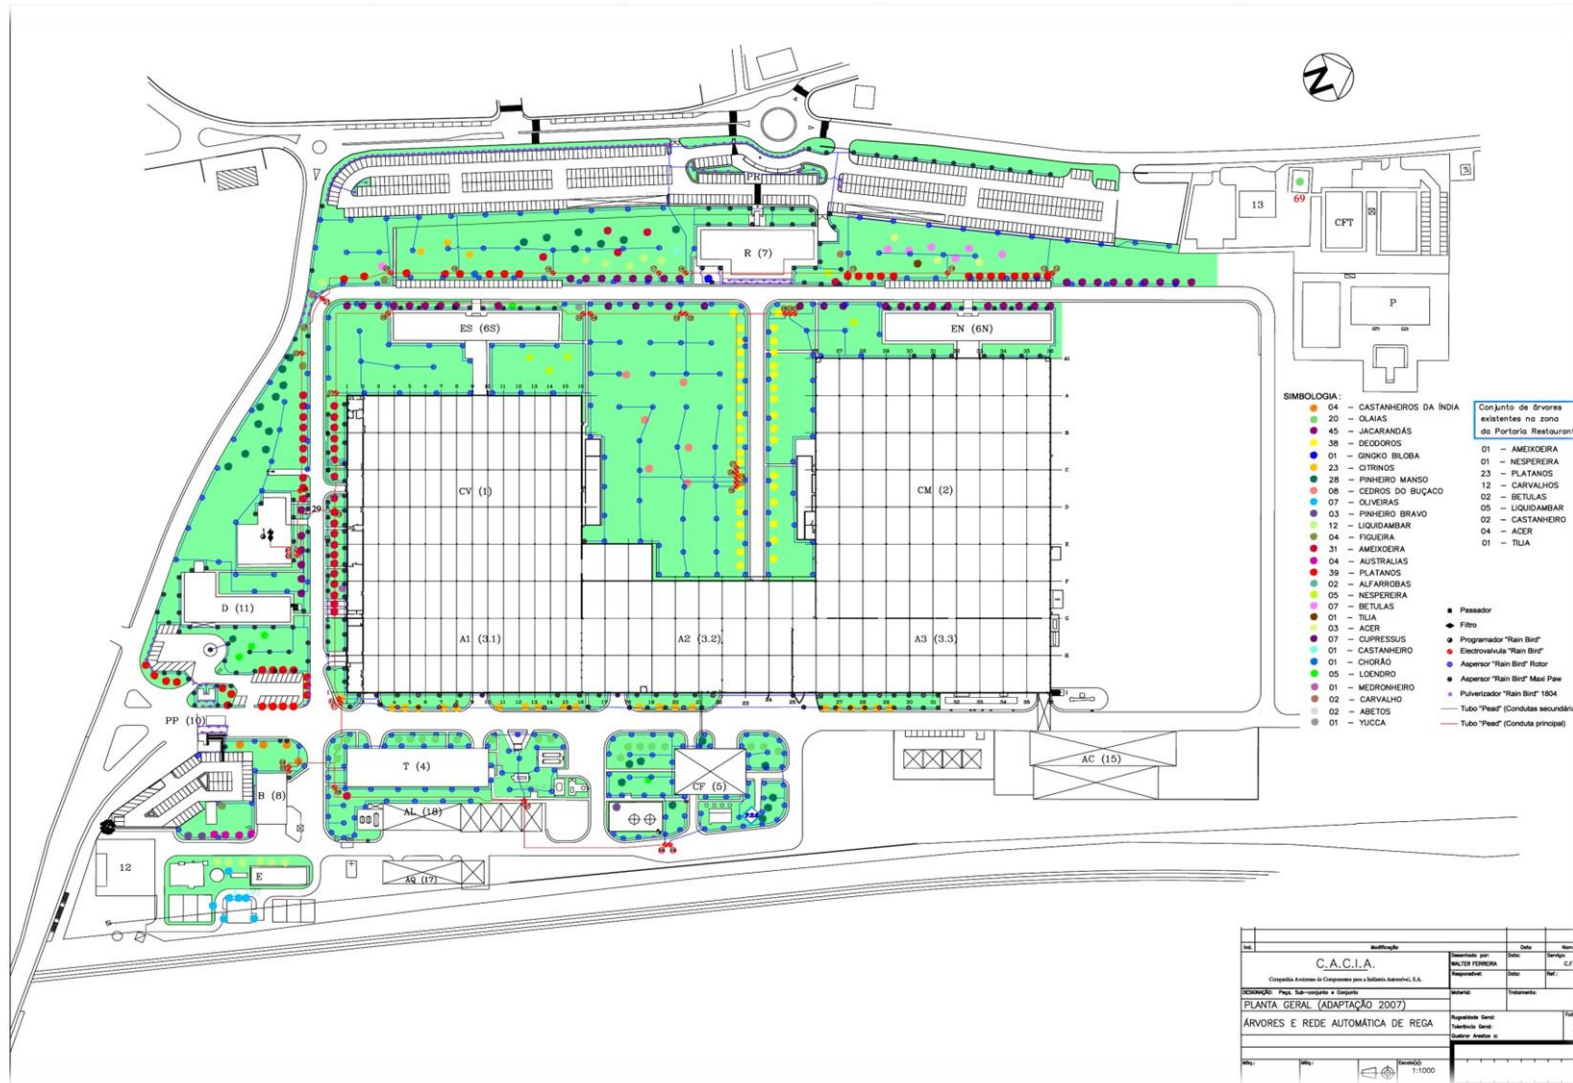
Planta geral da rede de rega, zonas relvadas e plantas existentes. (RENAULT C.A.C.I.A.)
